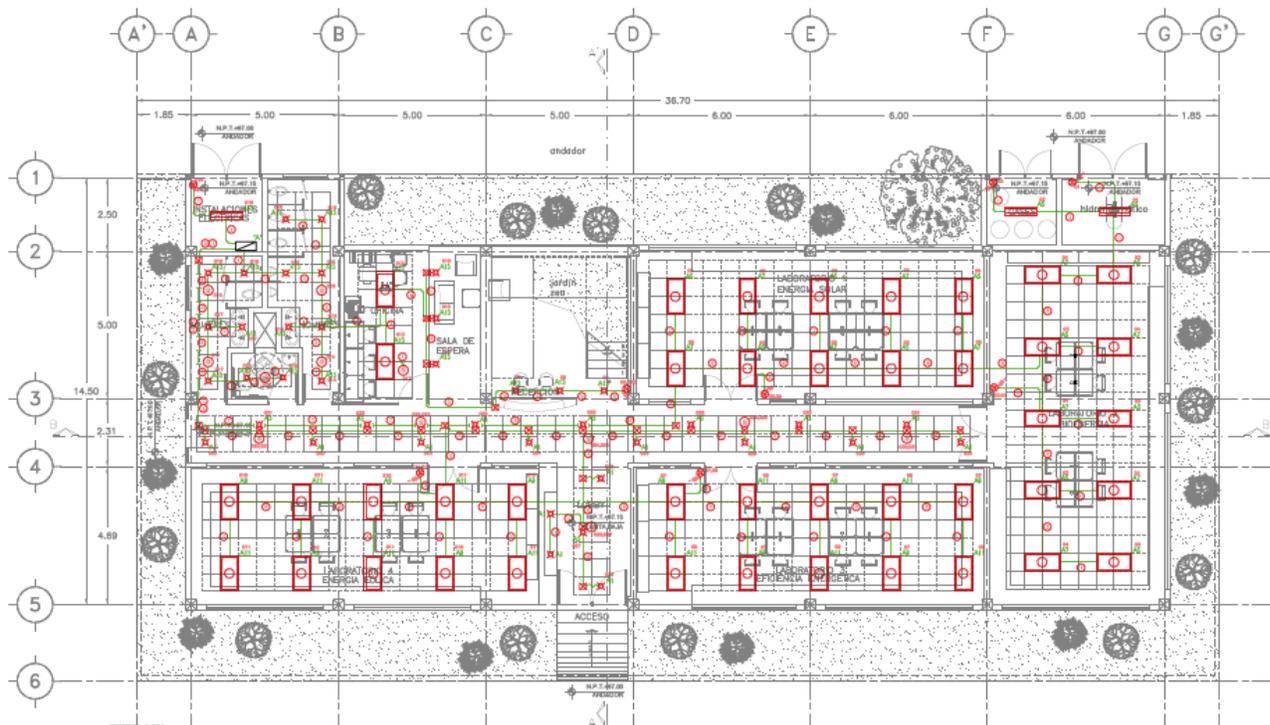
Aspecto general del sistema eléctrico de baja tensión que alimentará toda la instalación eléctrica de la planta baja de la nave y su área administrativa.
